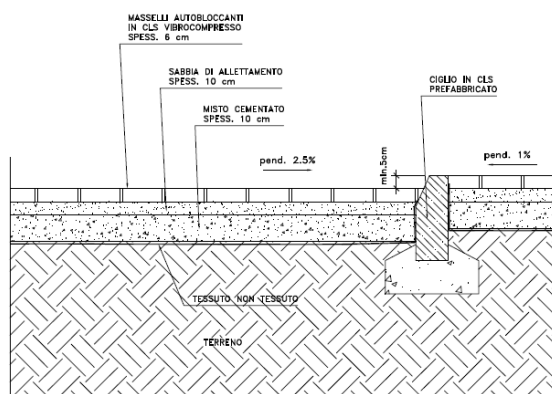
Vico I Fontana – Particolare pavimentazione
